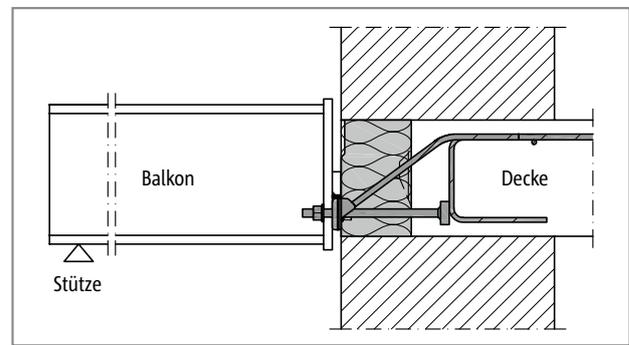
Schöck Isokorb® XT Typ SQ: Anschluss an die Stahlbetondecke; monolithische Konstruktion der Wand
